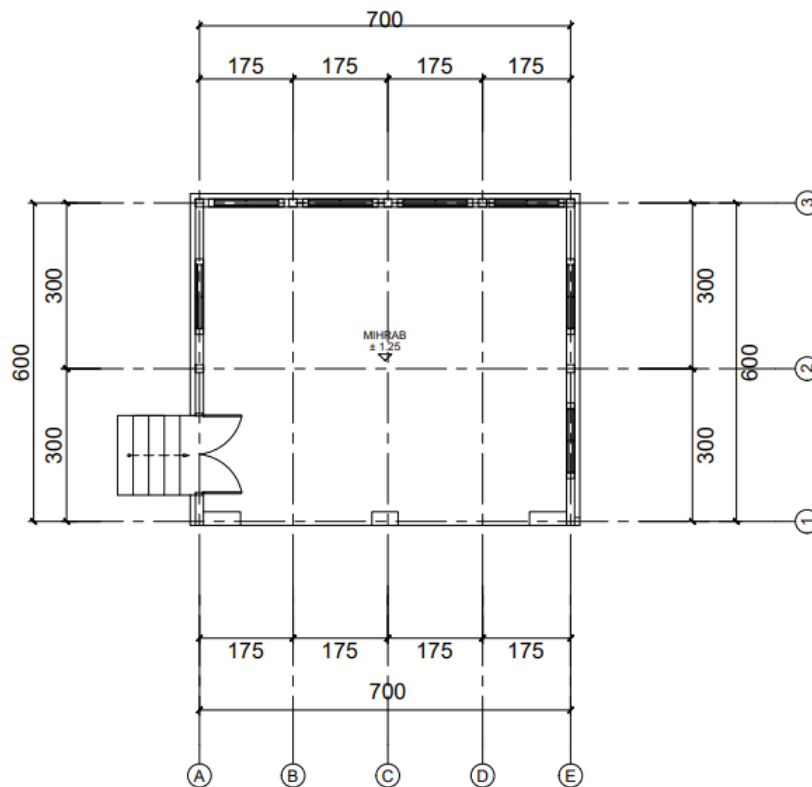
29 Denah interior Ruang Sholat Masjid
